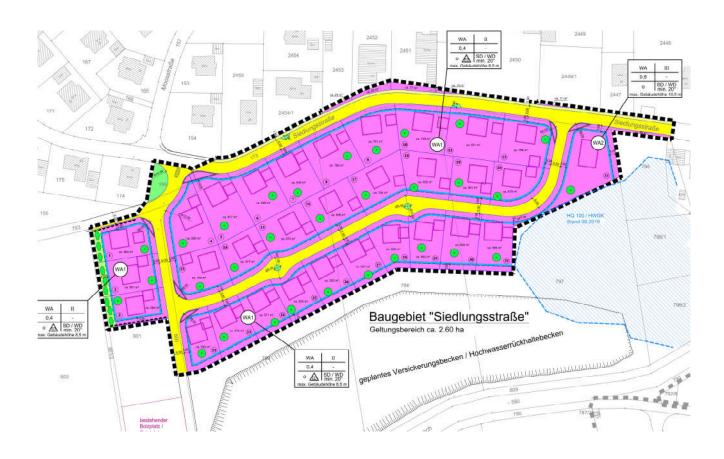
Lageplan, Auszug aus dem BPlan "Siedlungsstraße"
